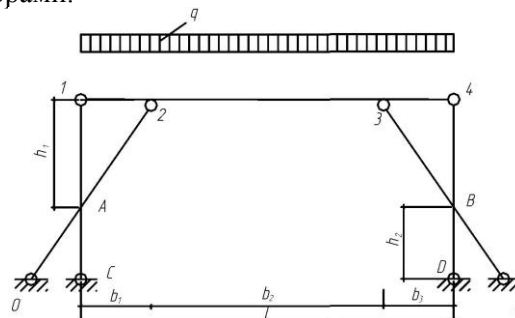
Схема загрузки каркаса рамно-балочного типа с X-образными опорами
